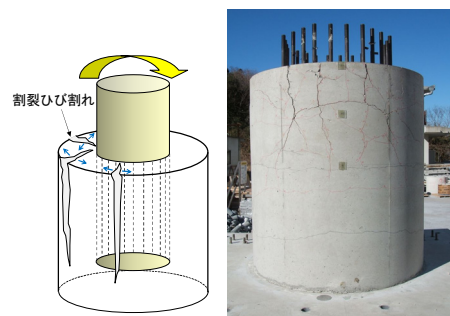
割裂ひび割れの概念図と既往の試験体のひび割れ状況
